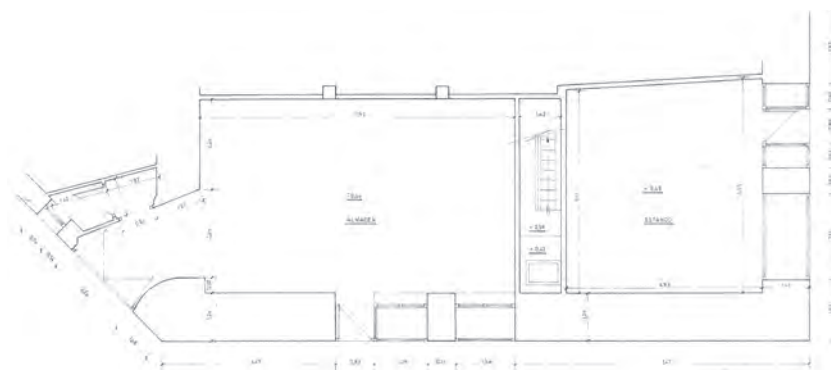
33. 1988. PLANTA BAJA REFORMADA²⁰
